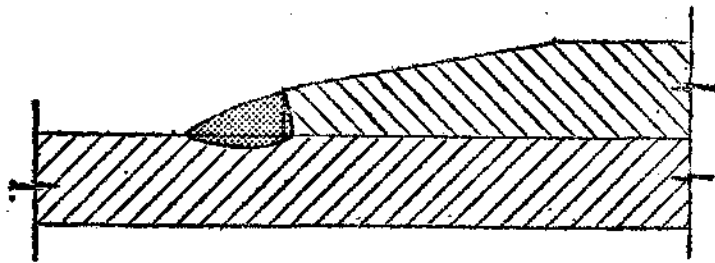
Soldadura frontal en el extremo de una platabanda traccionada
